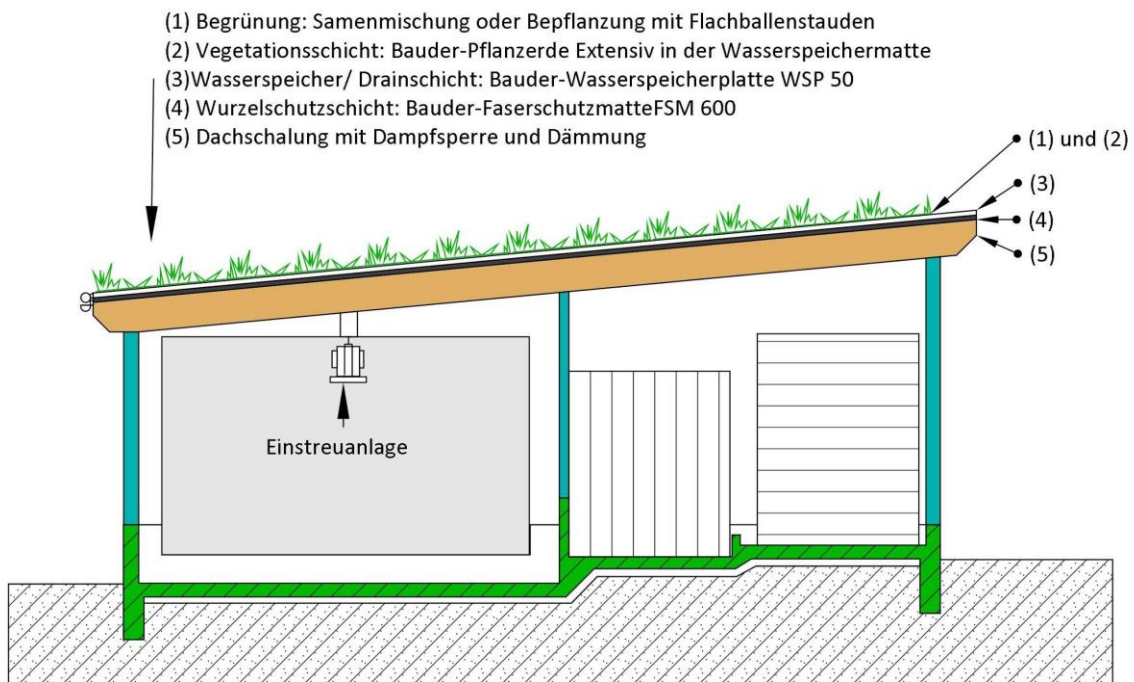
Dachaufbau mit wurzelfester Abdeckung und Wasserspeichermatte
